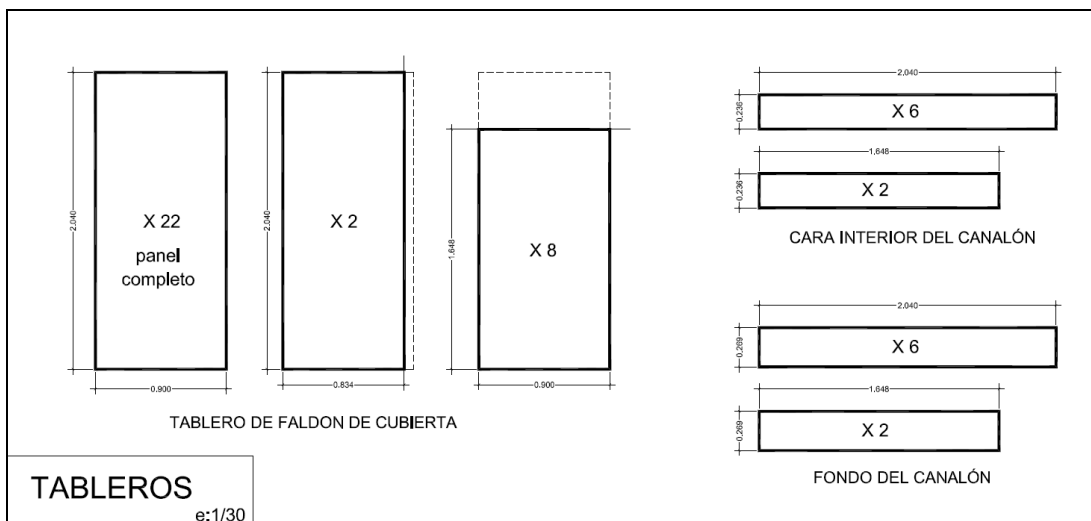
Diseño y despiece de los tableros del soporte de cubierta / [EP]
